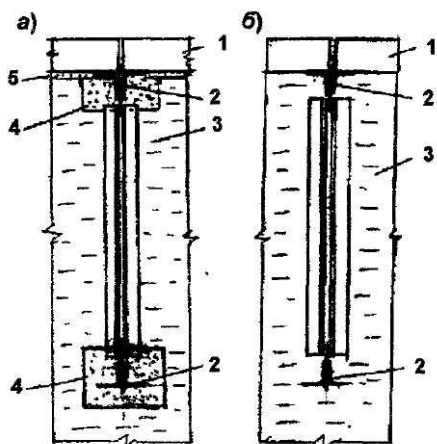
Схема пересечения стропильной фермы с перегородкой
